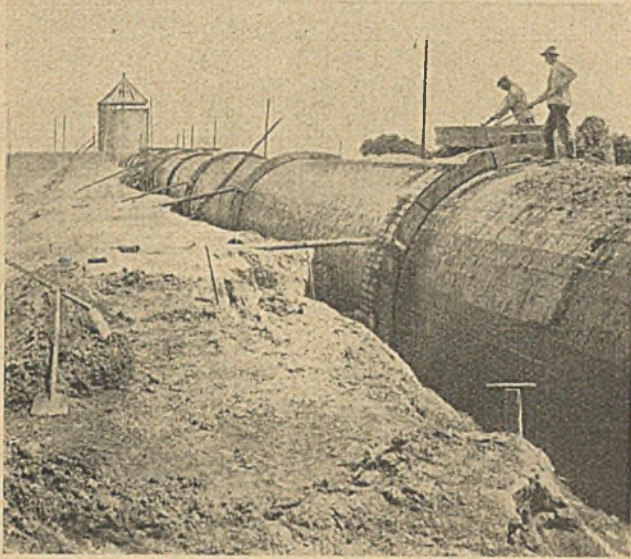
Fertige Eisenbetondruckrohrleitung.
